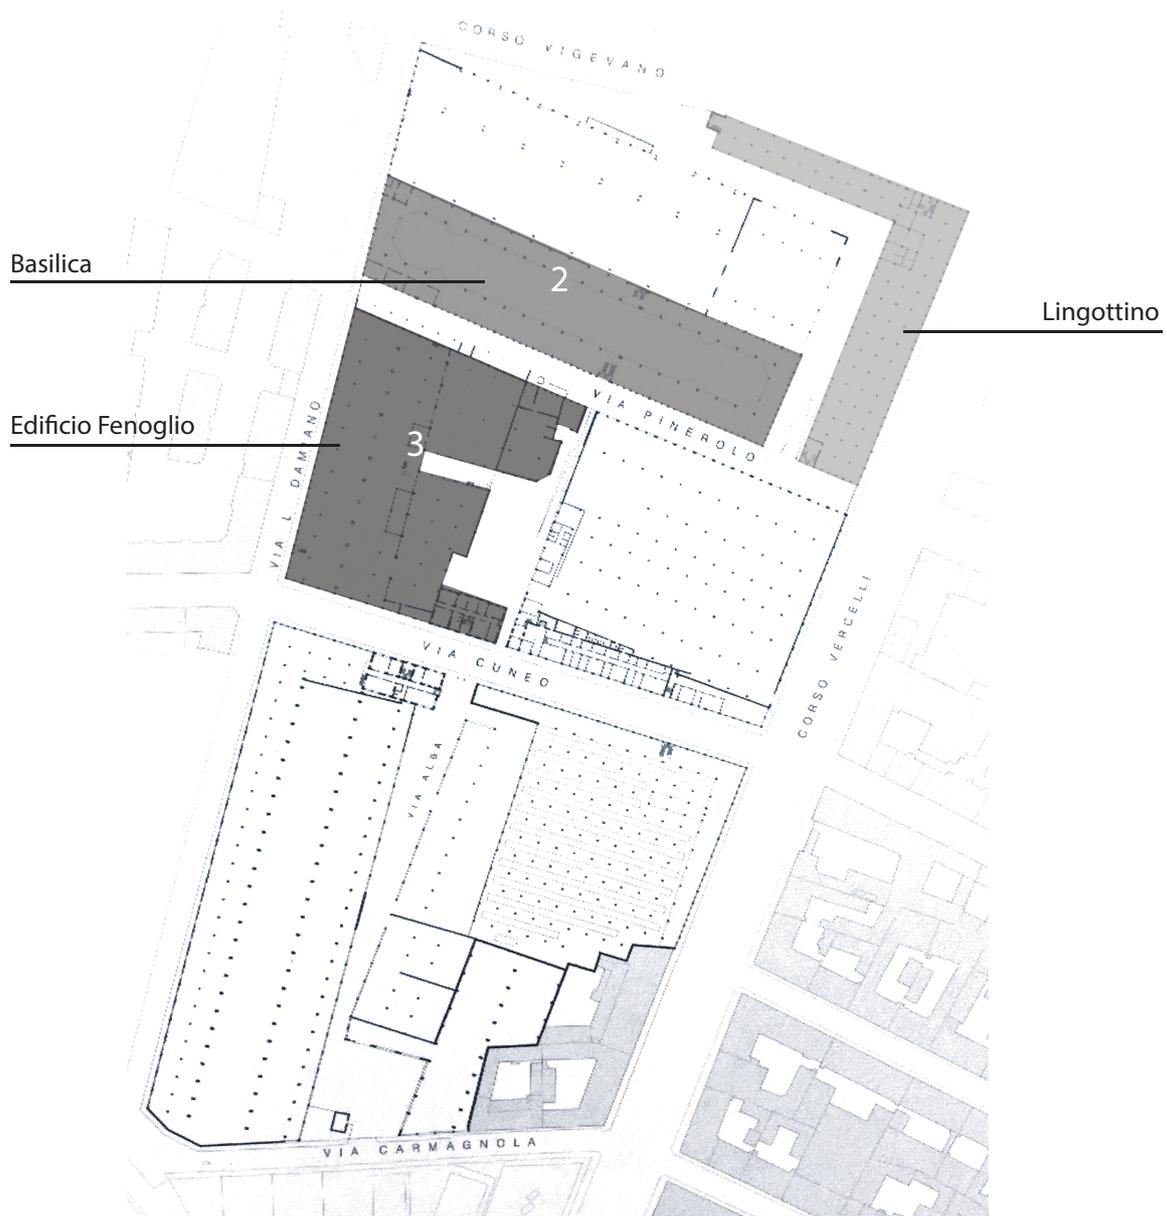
Planimetria dell'area ridisegnata dall'autore.
